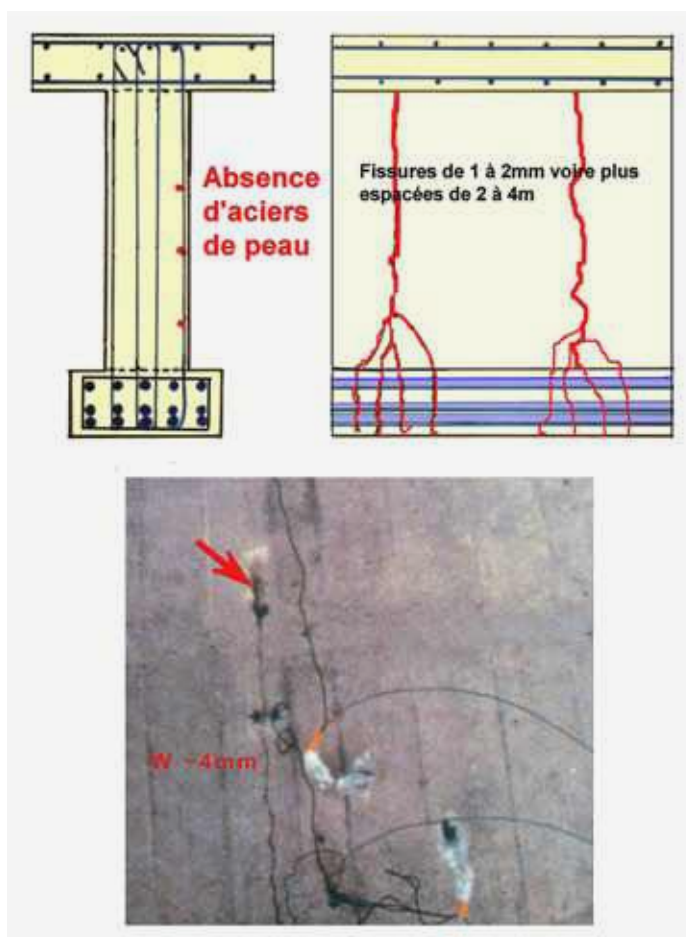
fissure de retruits gênés (crédit photo D. Poineau)
